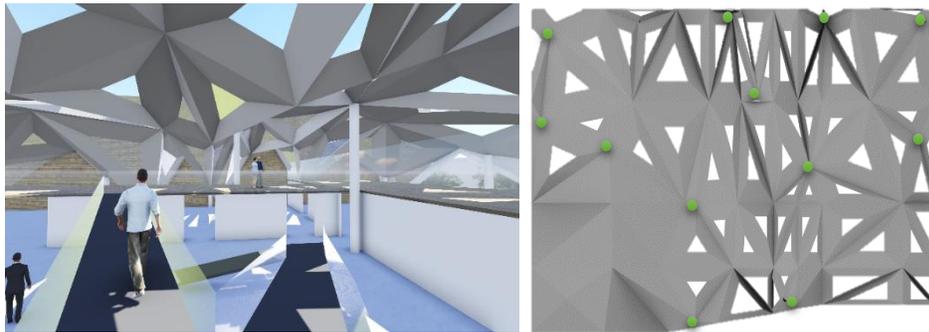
López N. (2016). Aplicación parámetro variable de Estructura en el Proyecto (Imagen). Elaboración propia.
